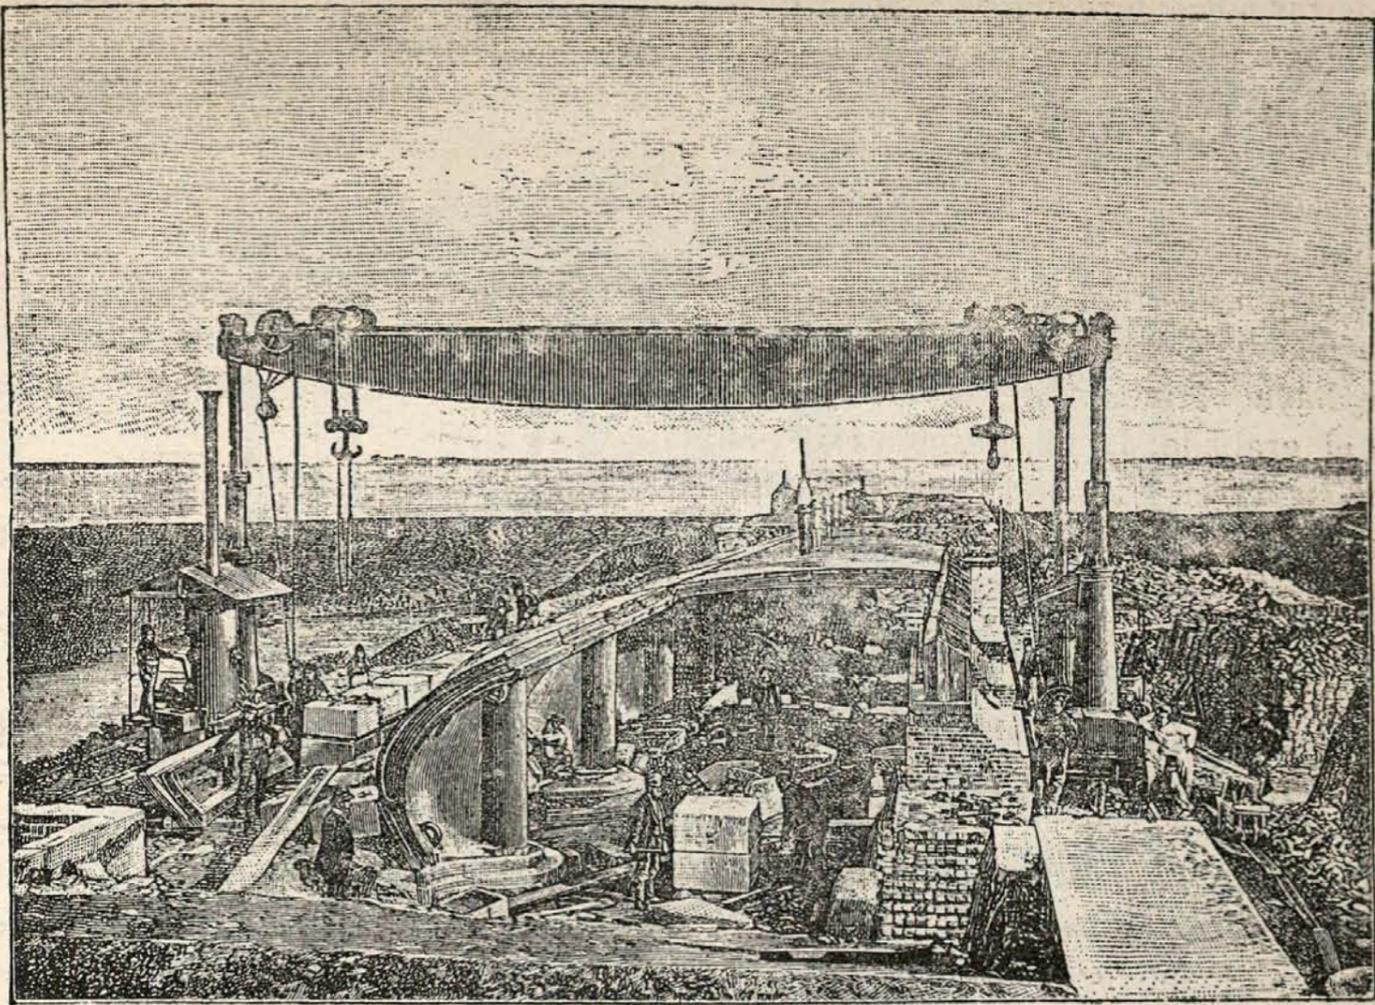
Batería acorazada para cañones de á 24. En construcción.
